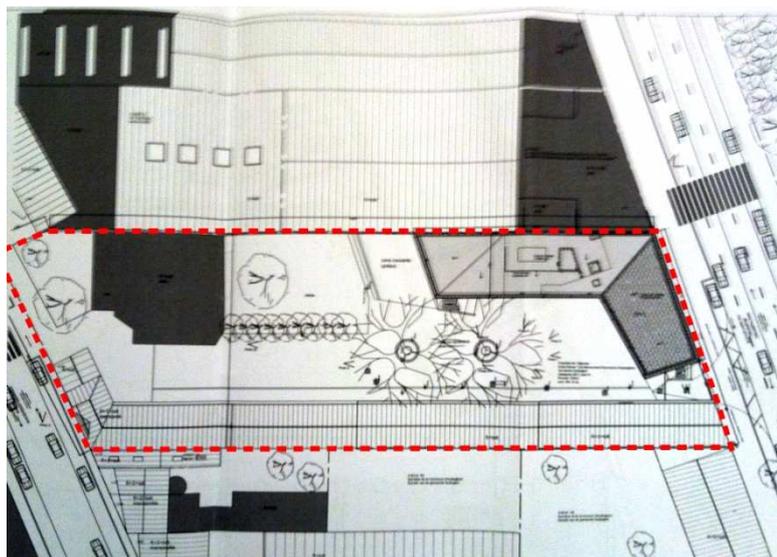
Extrait de la demande de permis d'urbanisme et du plan d'implantation (source : Arcanne).
